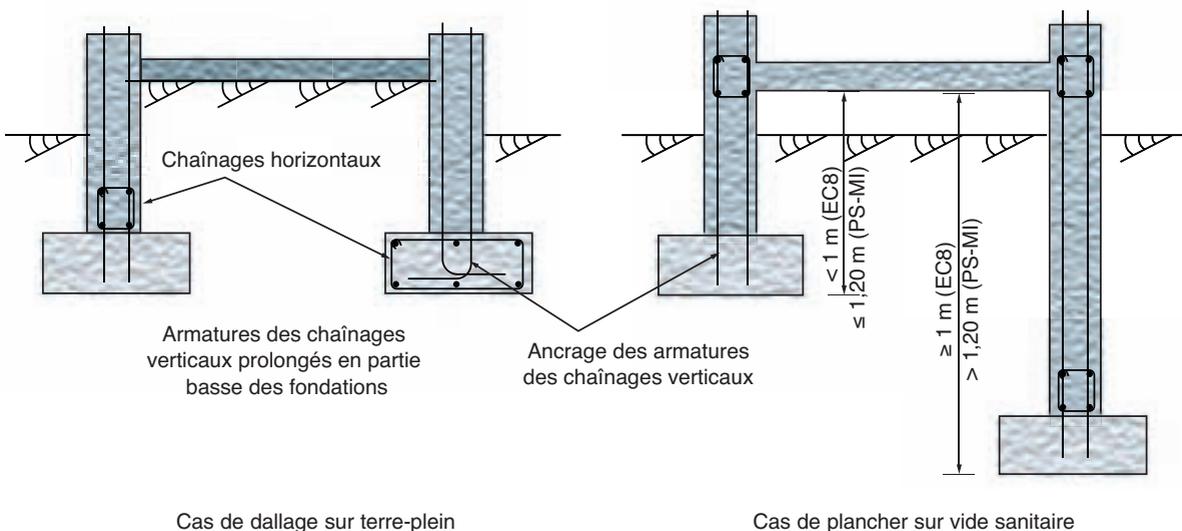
Chaînages au niveau des fondations en semelles filantes
